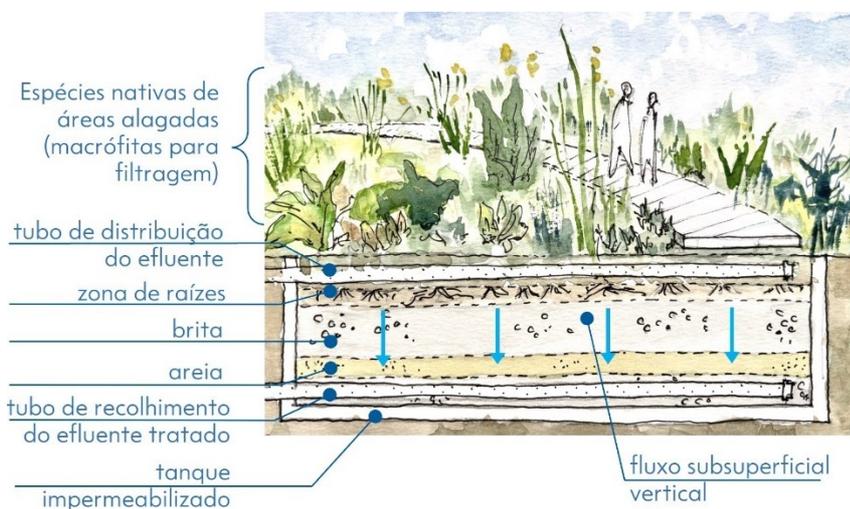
Corte esquemático de um alagado construído (fluxo subsuperficial vertical).
